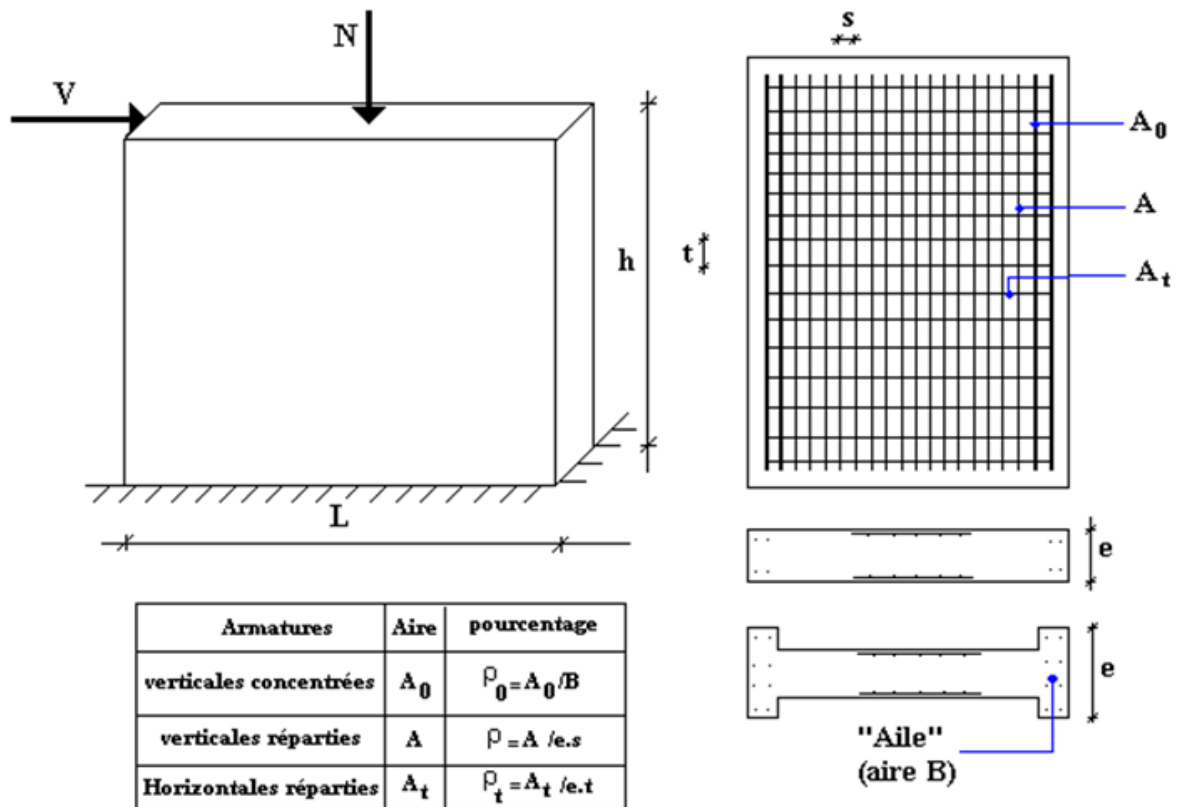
Schéma d'un voile plein et sa disposition de ferrailage
